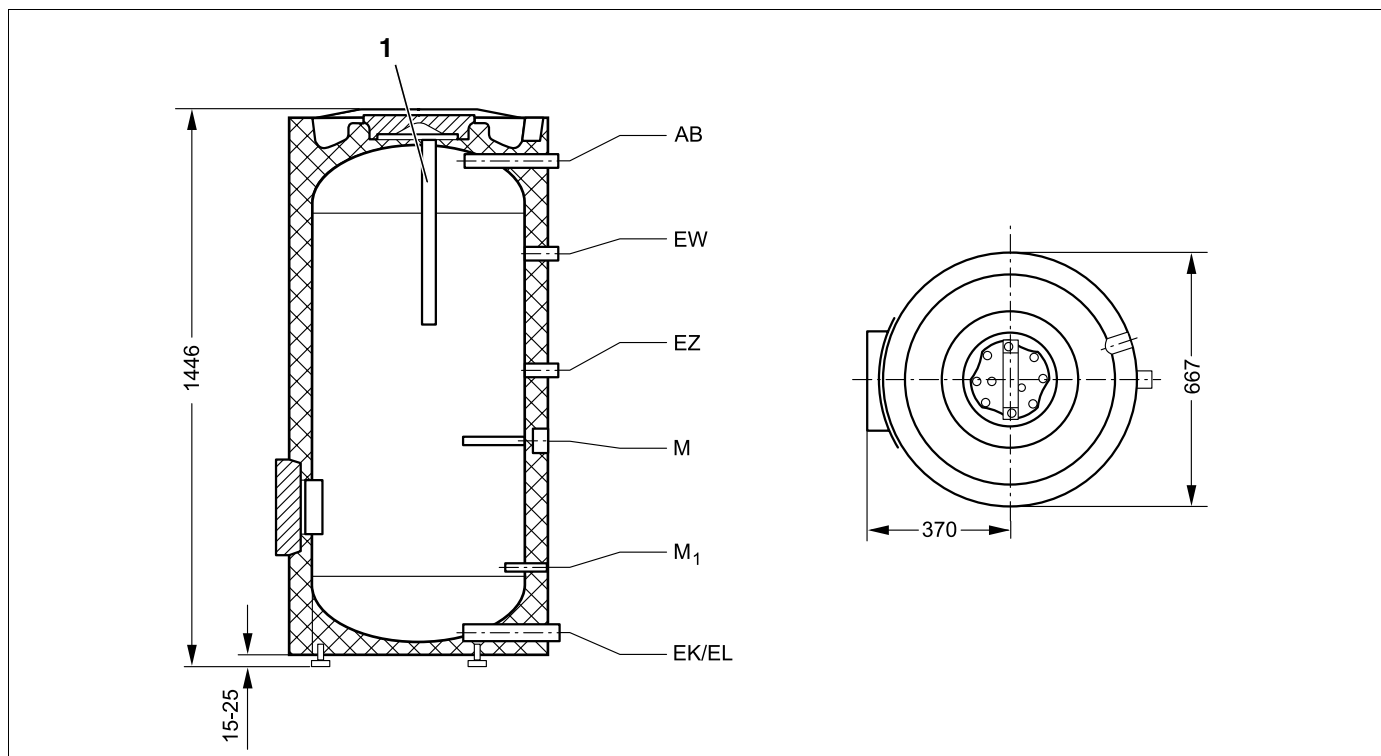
Dimensioni e attacchi (dimensioni in mm)
